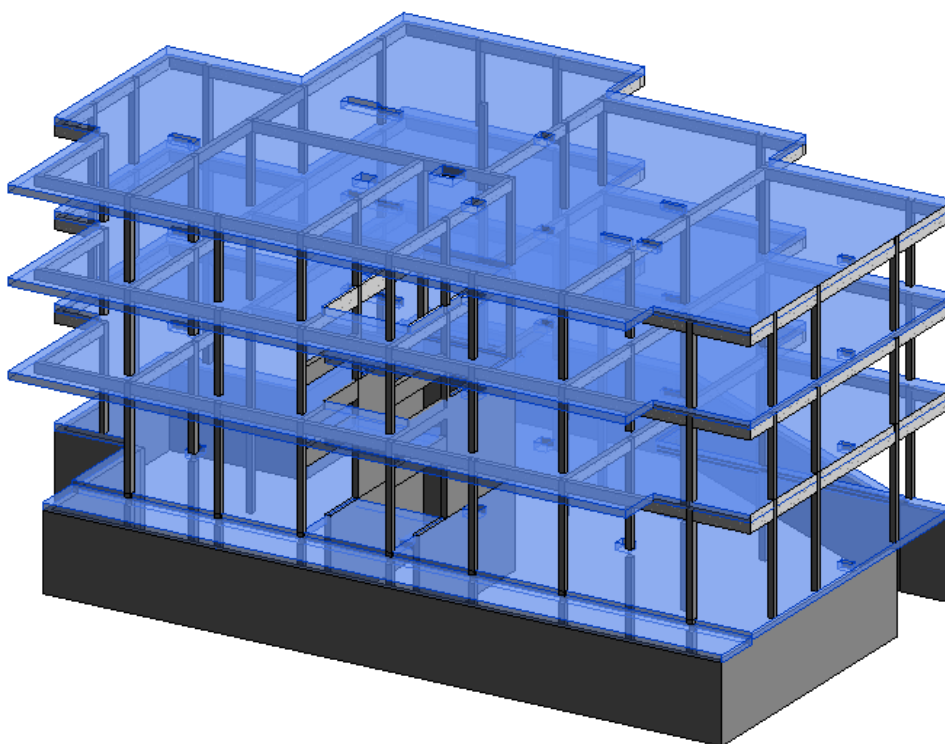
Modelação no *Revit* da estrutura com lajes apoiadas em vigas
